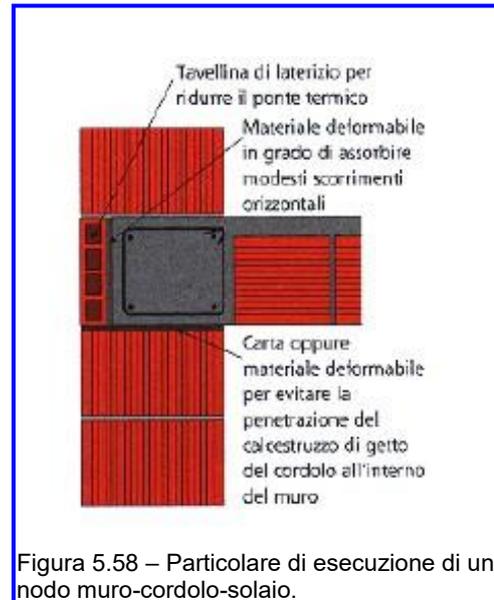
Particolare di esecuzione di un nodo muro-cordolo-solaio.
